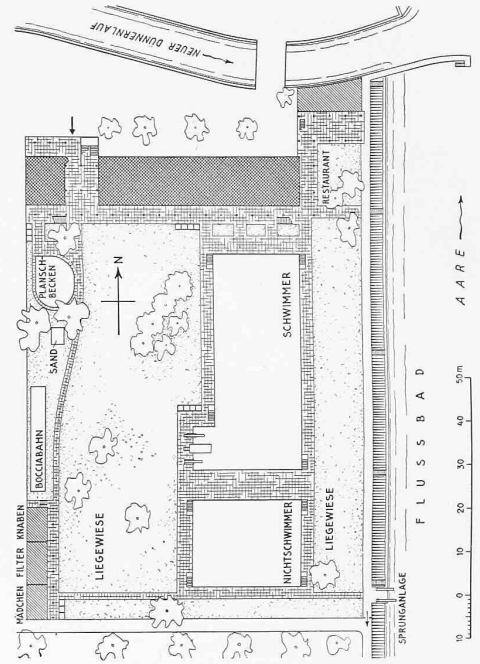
Lageplan Schwimmbad 1 : 1600.
